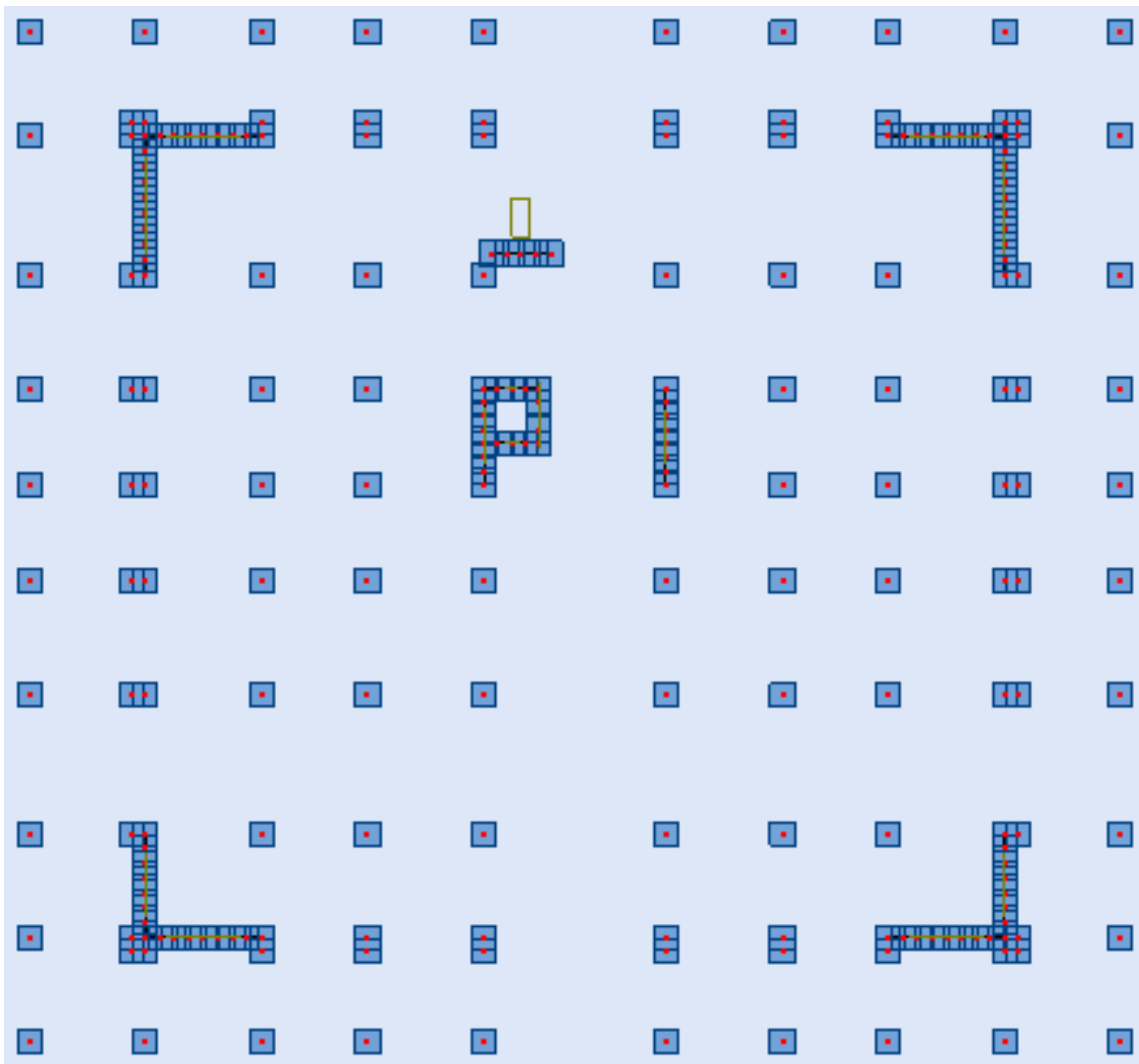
La 1<sup>ère</sup> disposition des murs voiles et poteaux (RDC + 15 étages).
